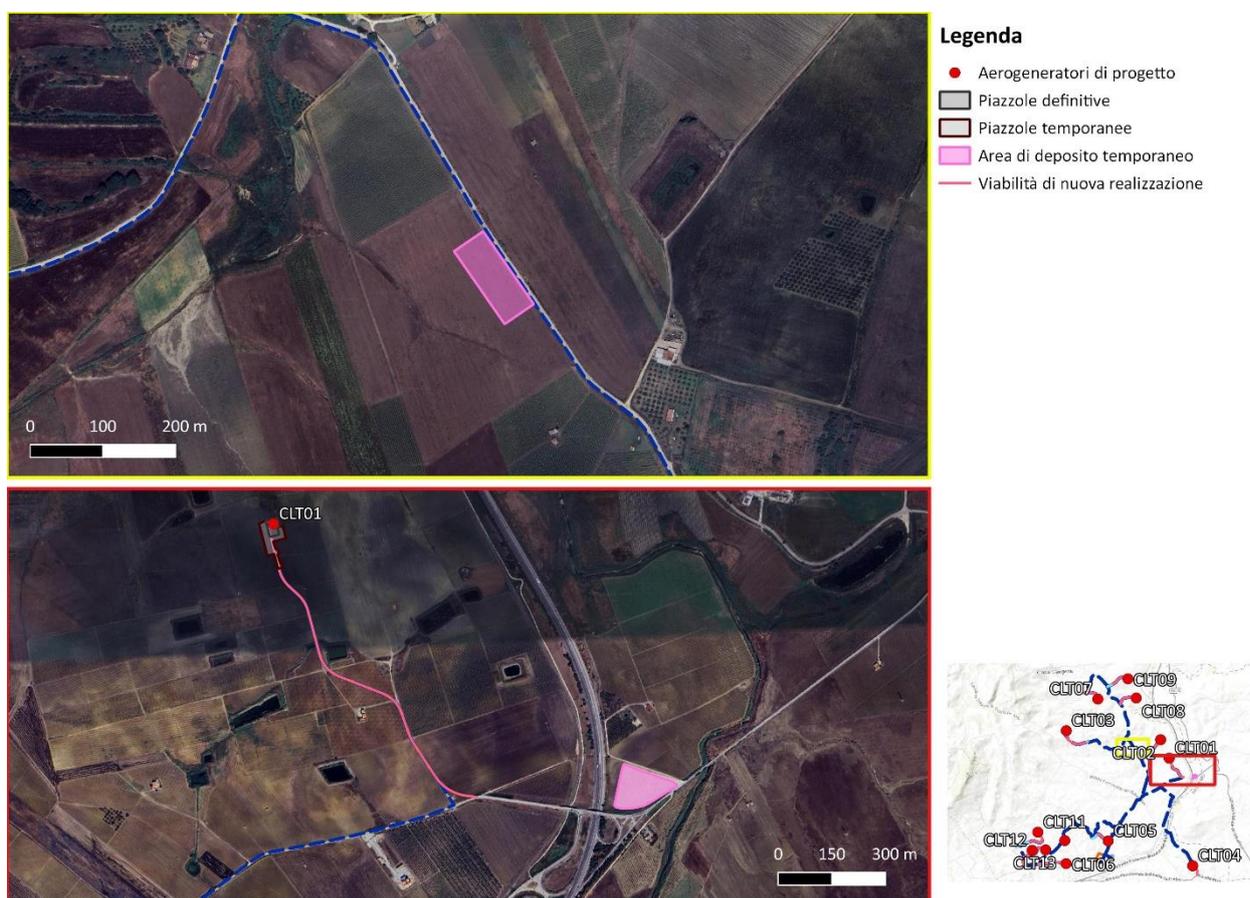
Localizzazione delle aree di deposito temporaneo per la fase di cantiere all'interno dell'impianto.
